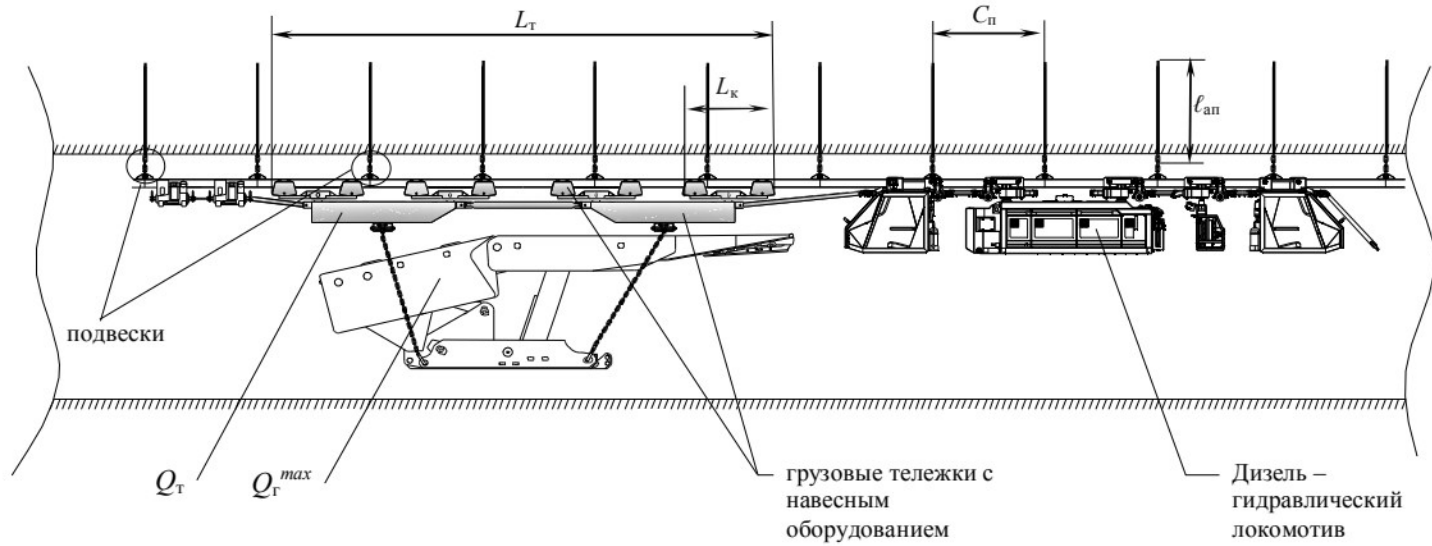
Схема к расчету нагрузок на подвески ПМД
